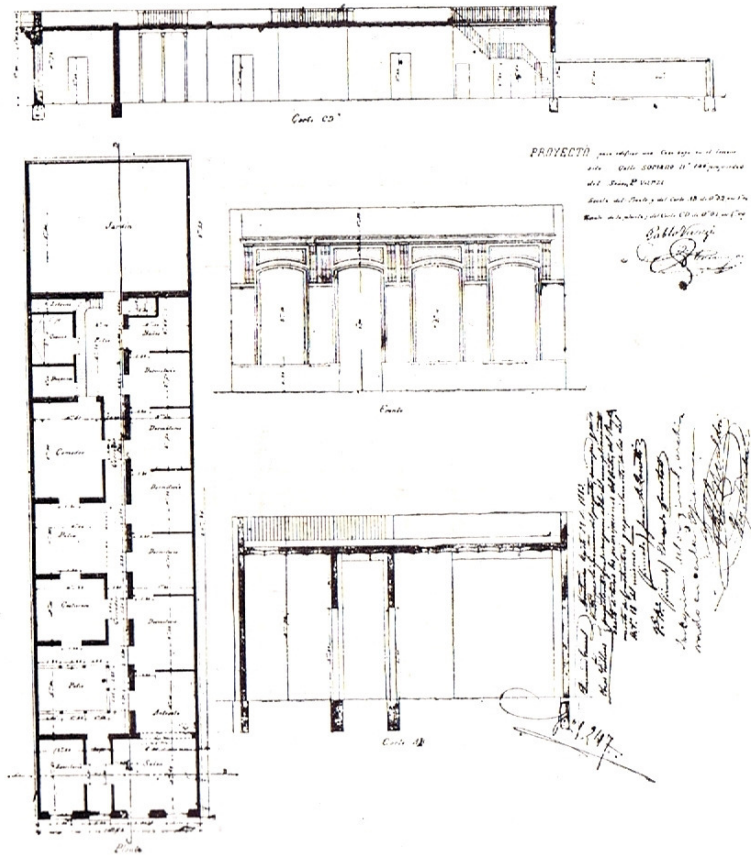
Casa "Standard" — Planta, fachada y cortes.
